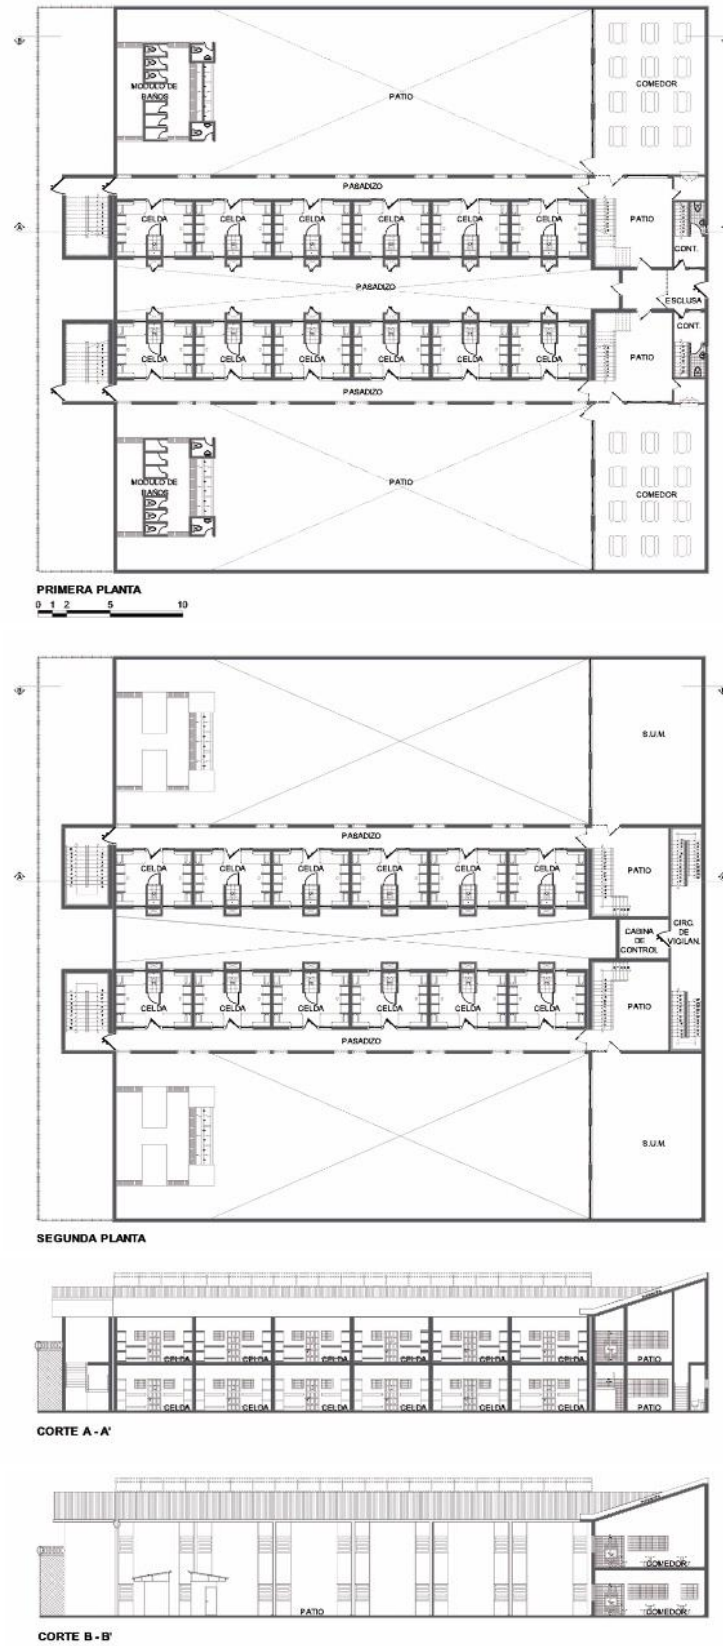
Plantas y corte del tratamiento de la zona A
